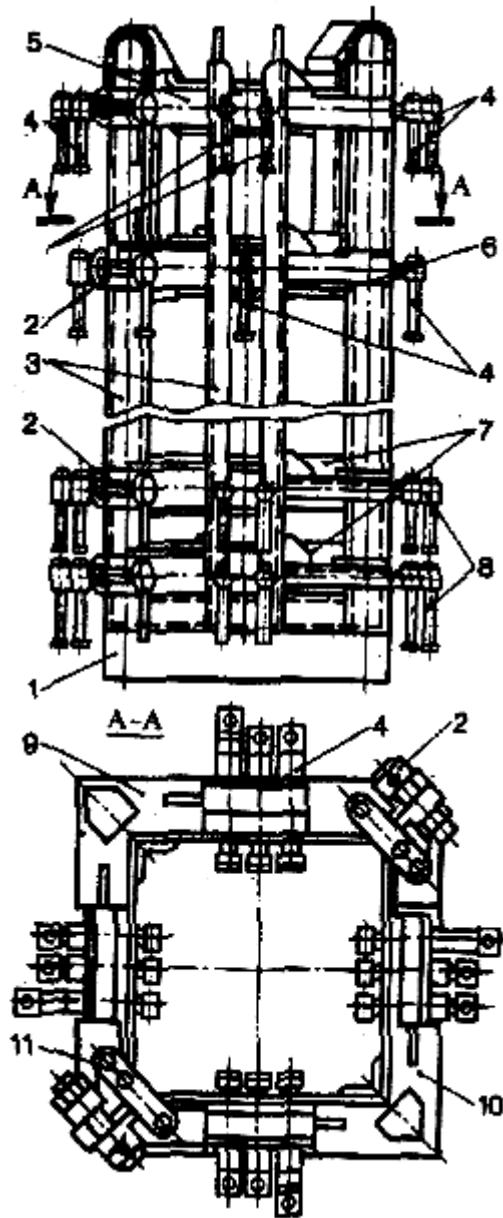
Одиночный кондуктор для закрепления и выверки колонн:
